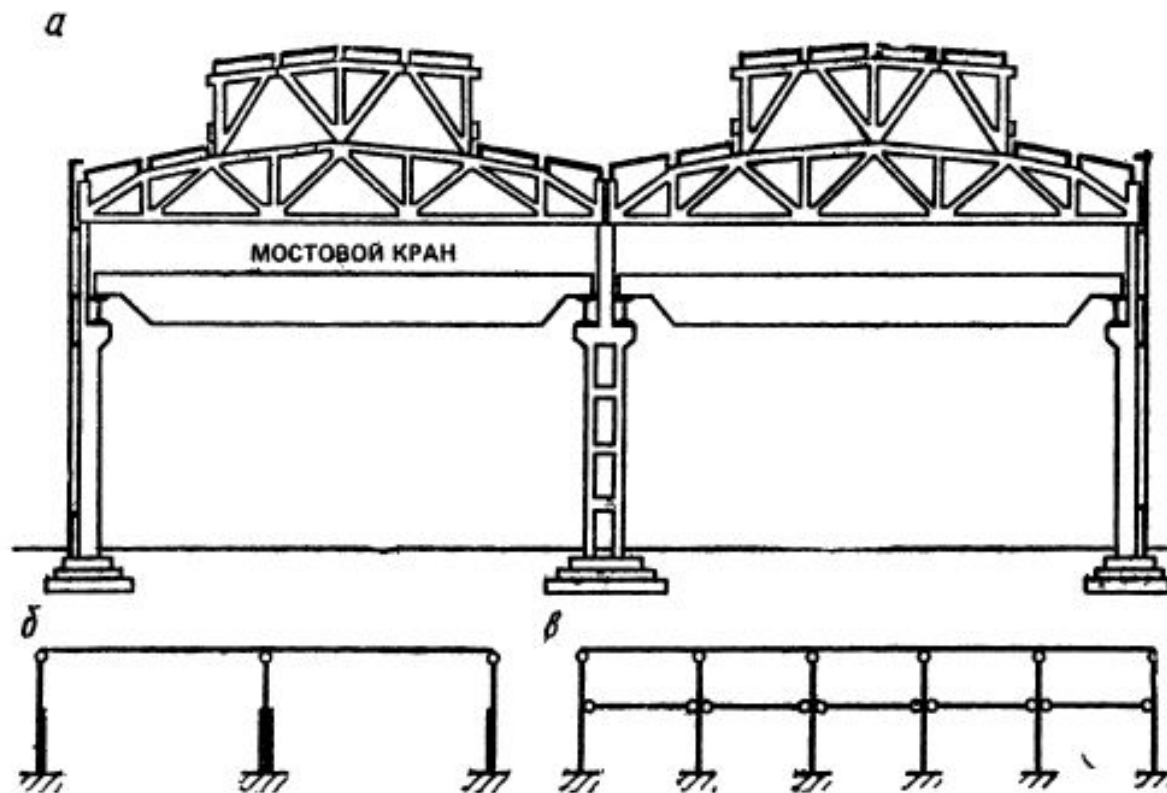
Одноэтажное промышленное здание с мостовыми кранами
